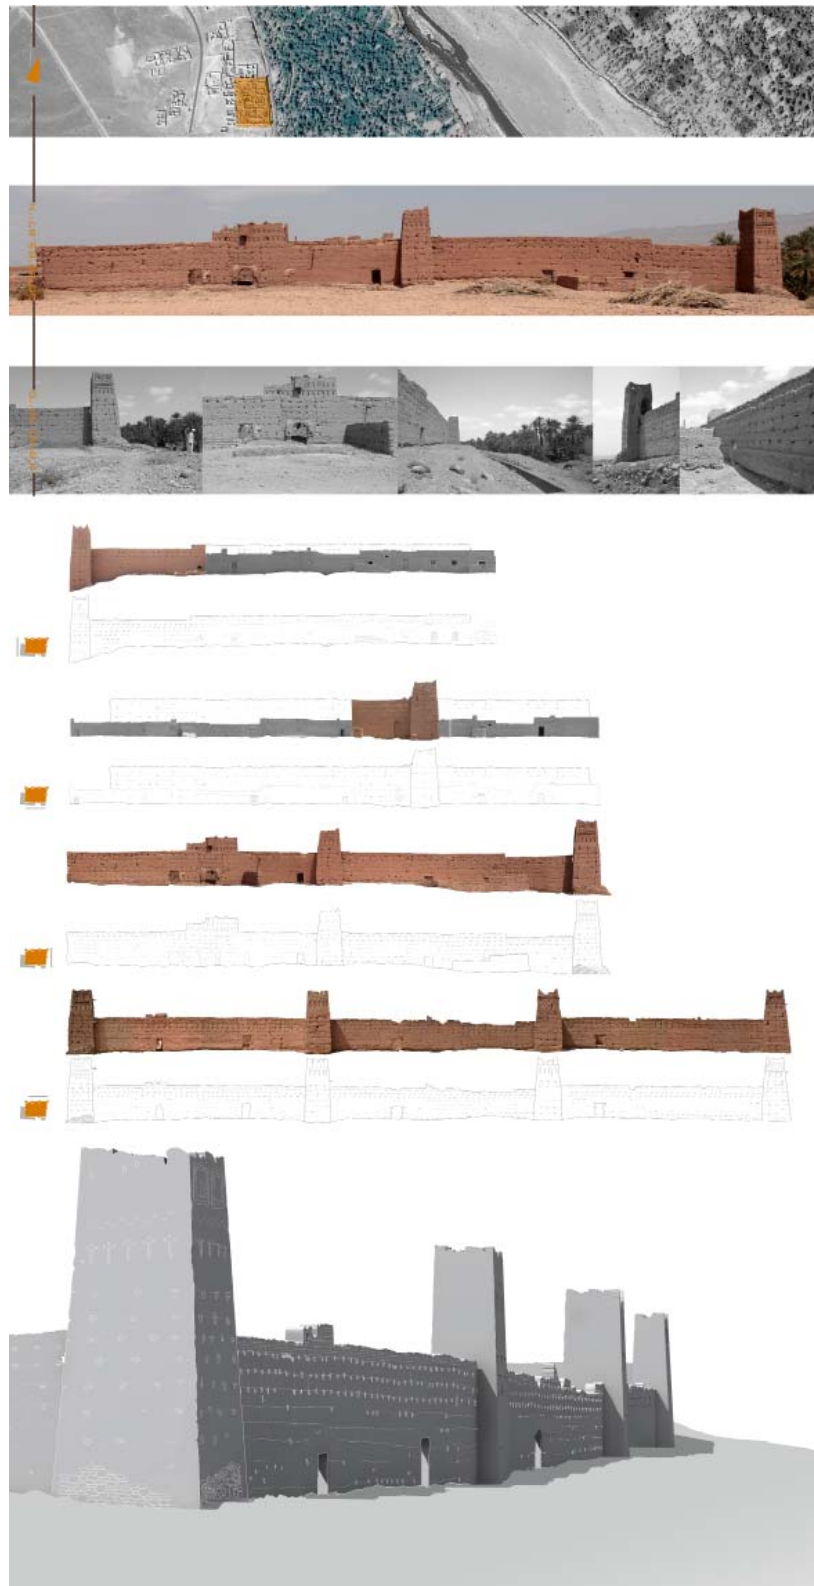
Ighemt di Afra Ouled Ad-Soltan.
